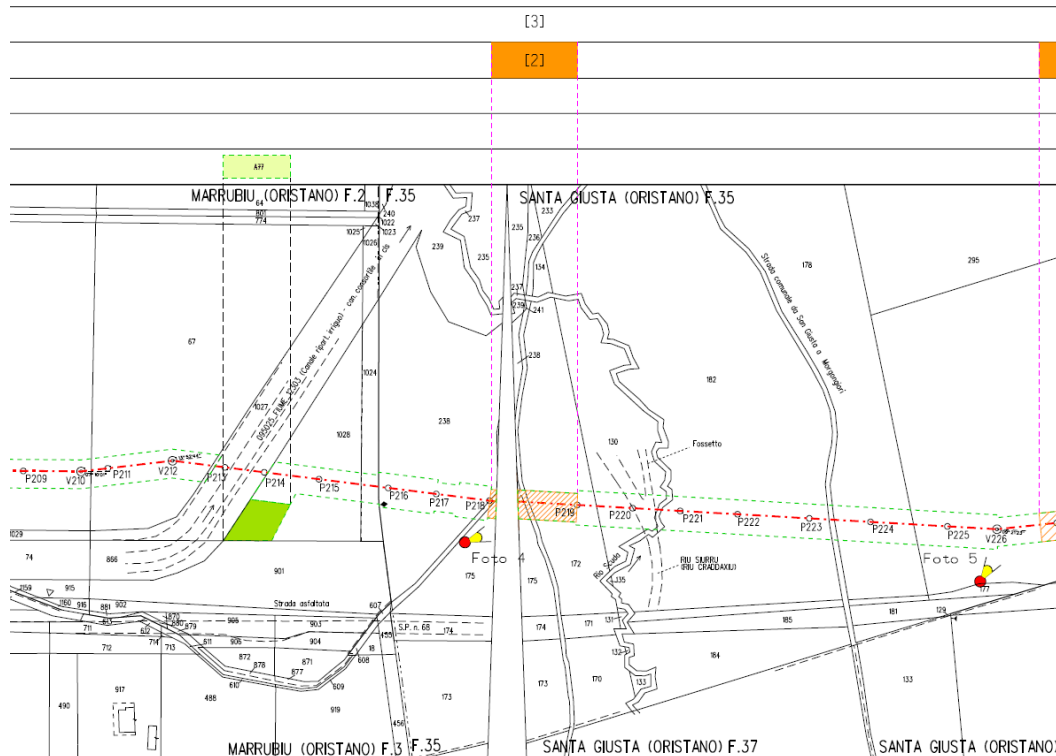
Tratto P218 - P219 - la zona delimitata dalle linee verdi rappresenta la fascia ristretta di lavoro per come previsto dalla GASD C 13.40.10.02
